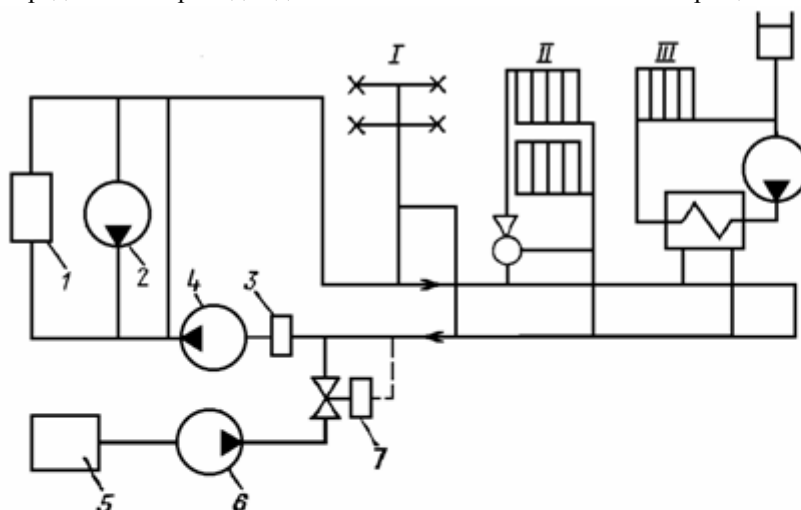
Принципиальная схема теплоснабжения от водогрейной котельной: I – система горячего водоснабжения; II – система отопления и вентиляции; III – система отопления и теплоснабжения других видов (присоединение к тепловой сети через поверхностные теплообменники); 1 – котельная с водогрейными котлами; 2 – рециркуляционный насос; 3 – грязевик; 4 – сетевые насосы; 5 – химводоочистительная установка; 6 – подпиточный насос; 7 – регулятор подпитки
